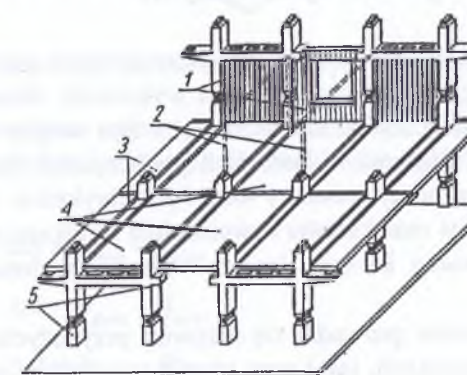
Schemat konstrukcji szkieletowej złożonej z prefabrykowanych słupów i belek [10]
